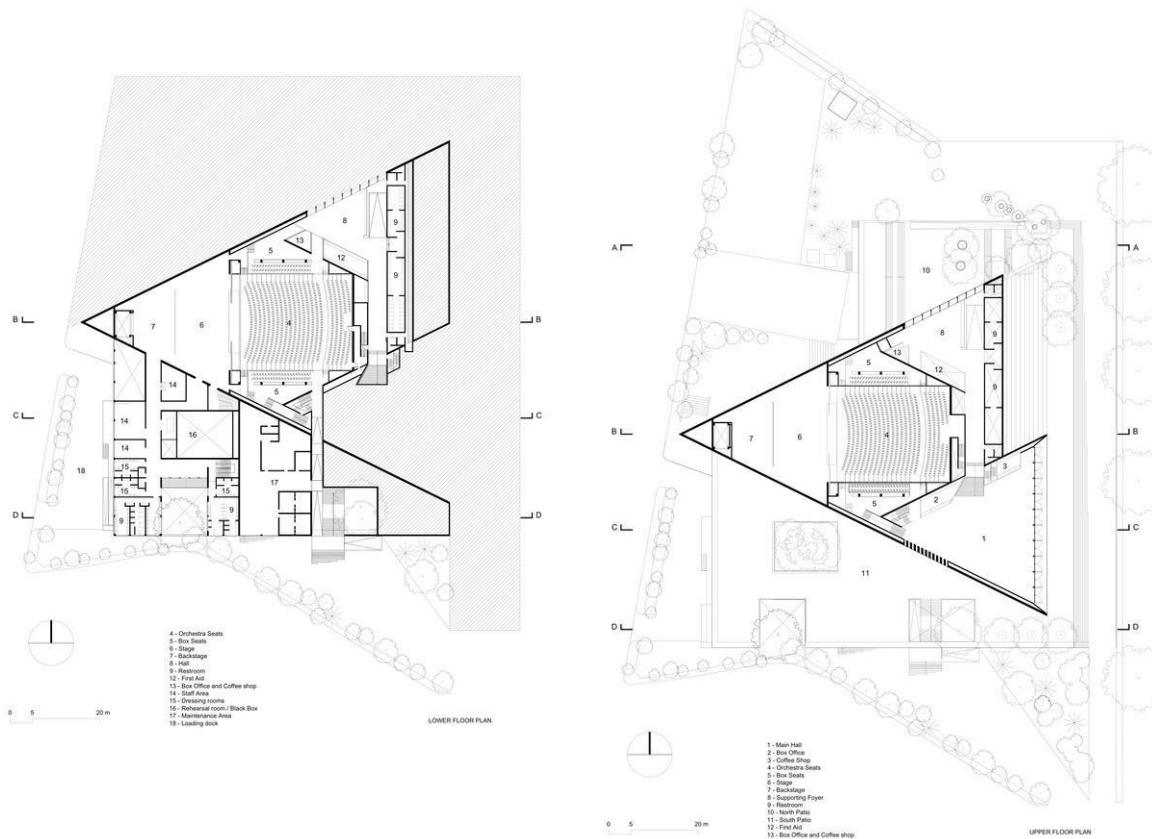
Planos de Planta Centro cultural Teopanzolco
